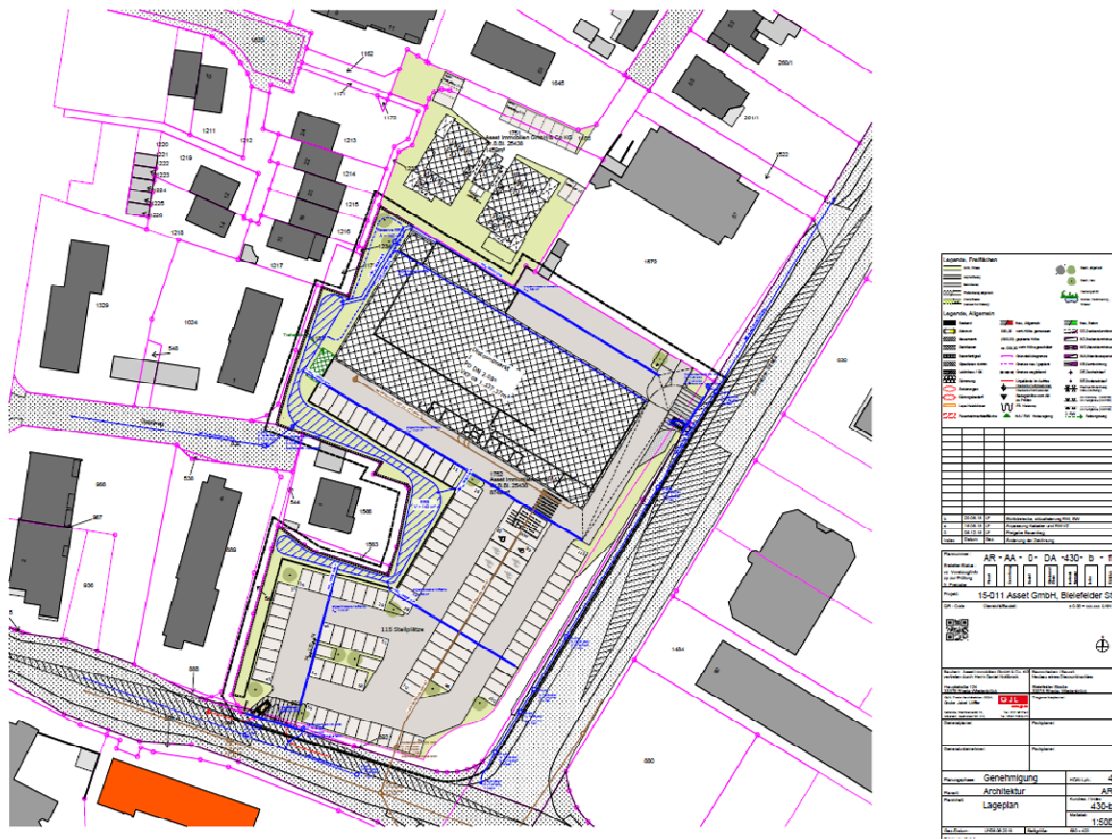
Lageplan der geplanten Wohnbebauung nördlich des geplanten Discoutmarktes (GJL 2018).
